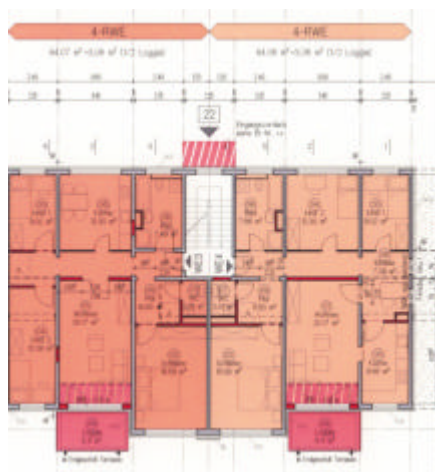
Grundrisse des familiengerechten Wohnens im Niedrigenergiehaus Tallinner Straße 22 und 24
